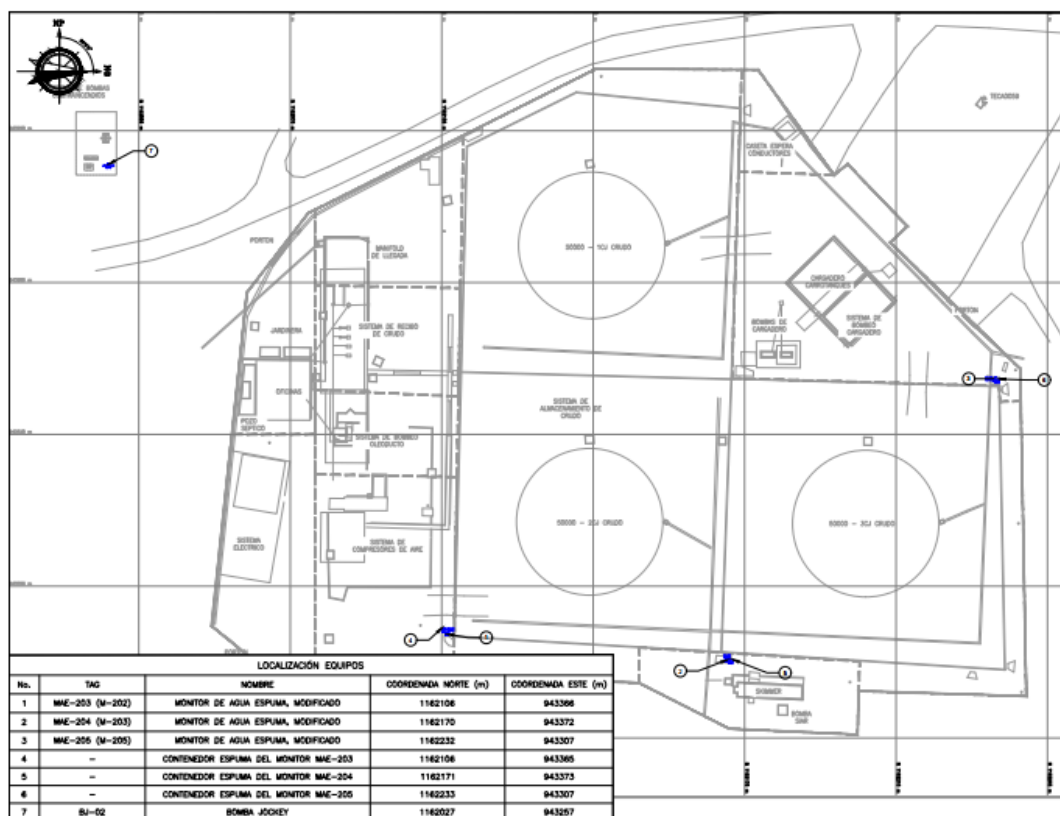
Plot Plan de localización de equipos de extinción en la planta de almacenamiento de crudo, (Pasante, 2019).
